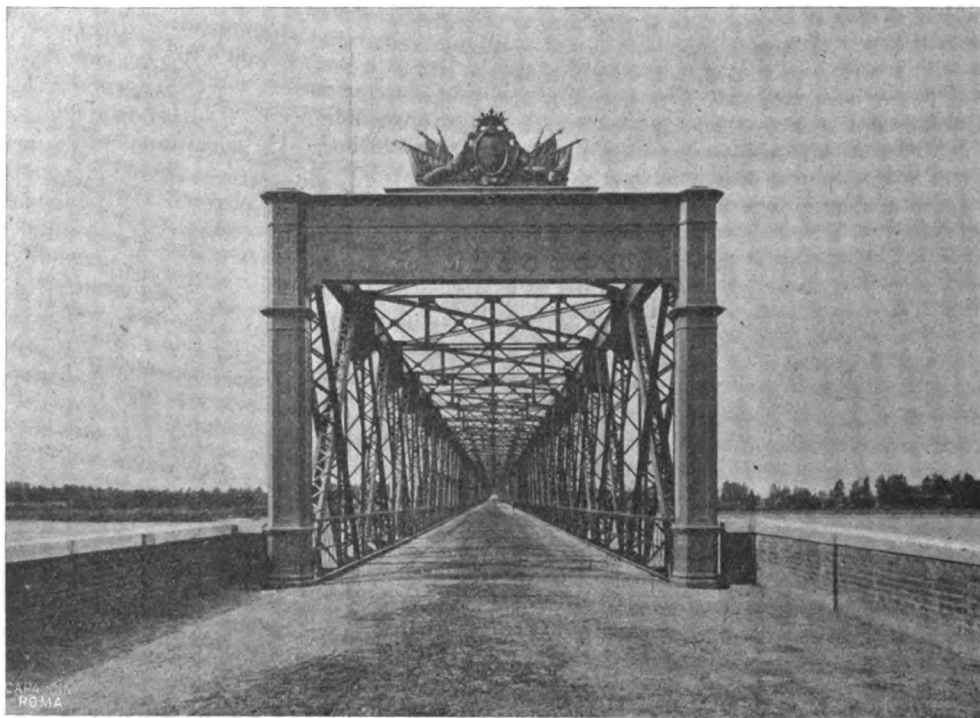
Ponte sul Po alla Becca presso Pavia. - Vista di prospetto.
